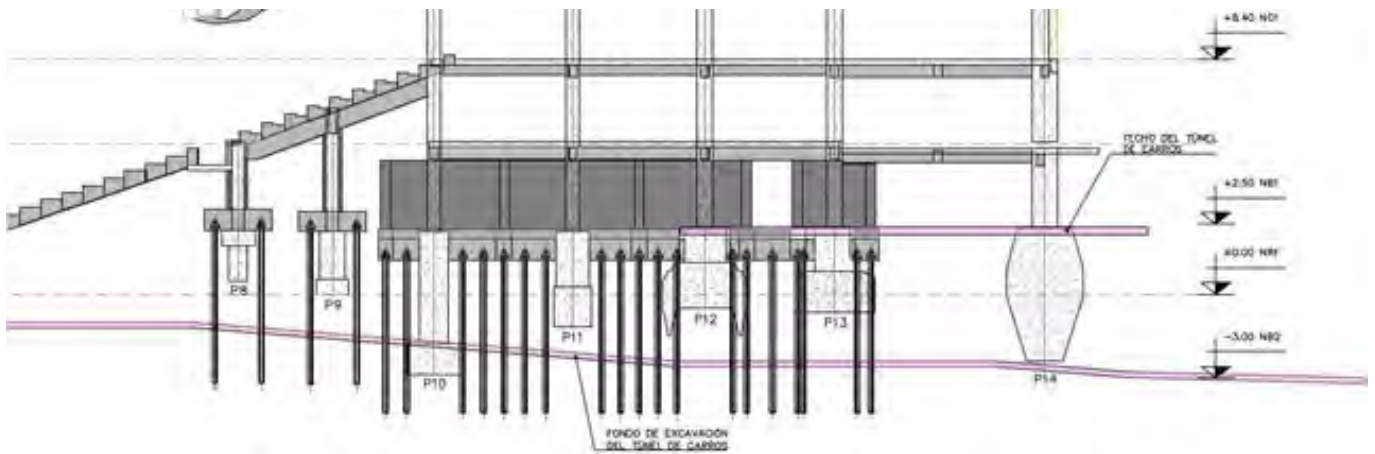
Hormigonado de la rejilla inferior y puesta en funcionamiento. Procedente del proyecto de ejecución.
